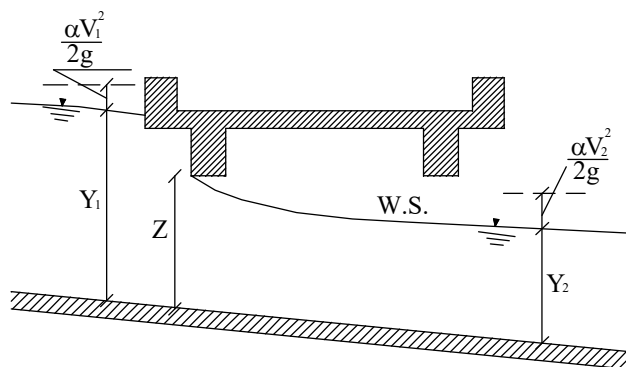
Sezione schematica di un ponte – Schema di calcolo
